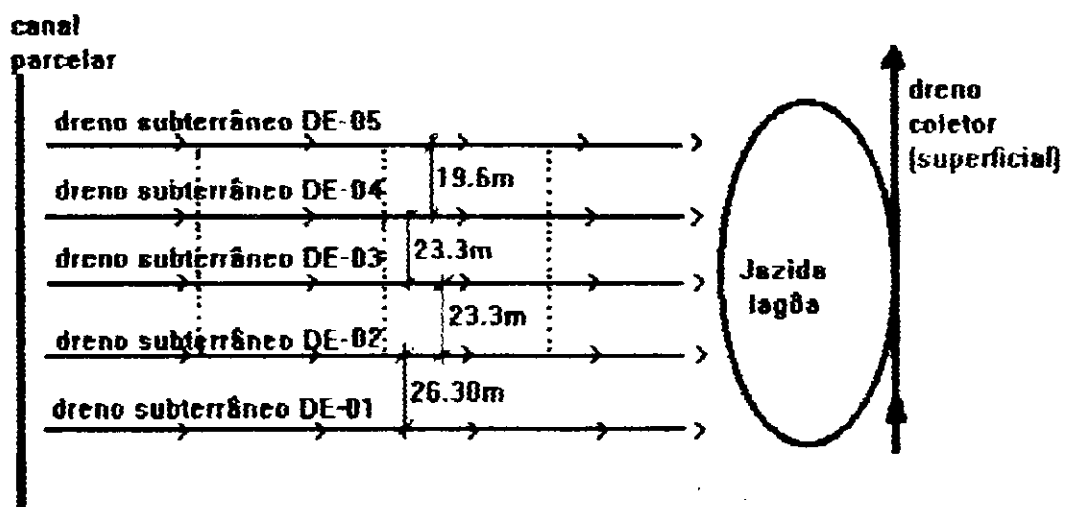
Layout do lote 082 do ensaio 3 do perímetro Bebedouro
